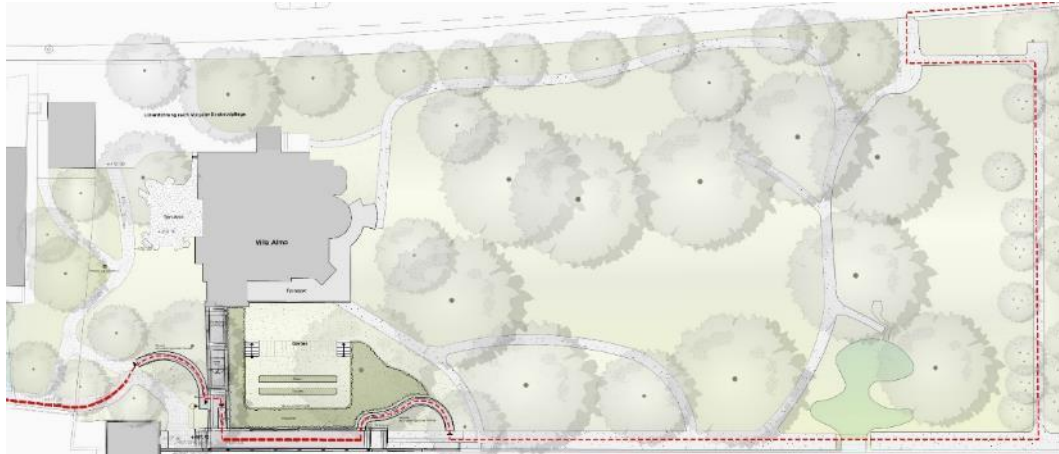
Planausschnitt Variante 1 – Wegführung mit Rampen
